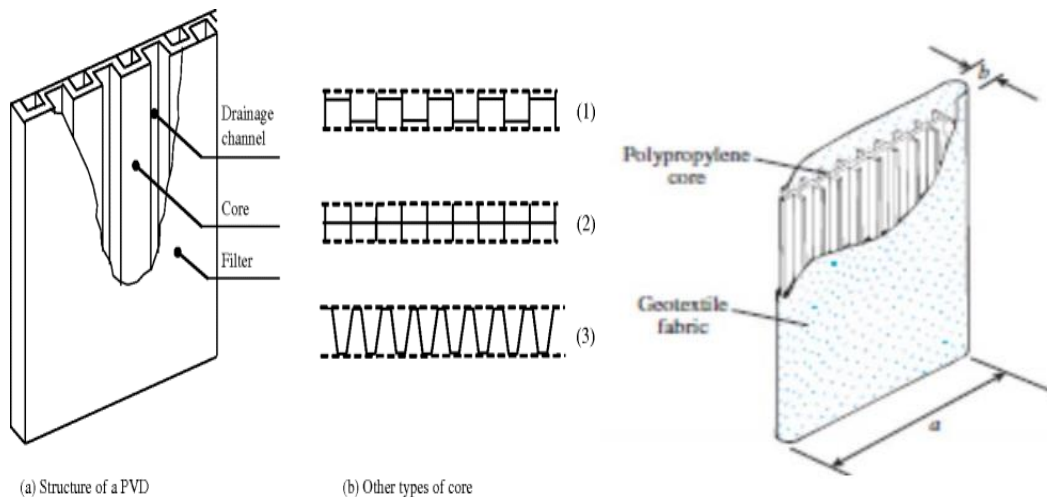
Drains verticaux préfabriqués (Das, 1983)
